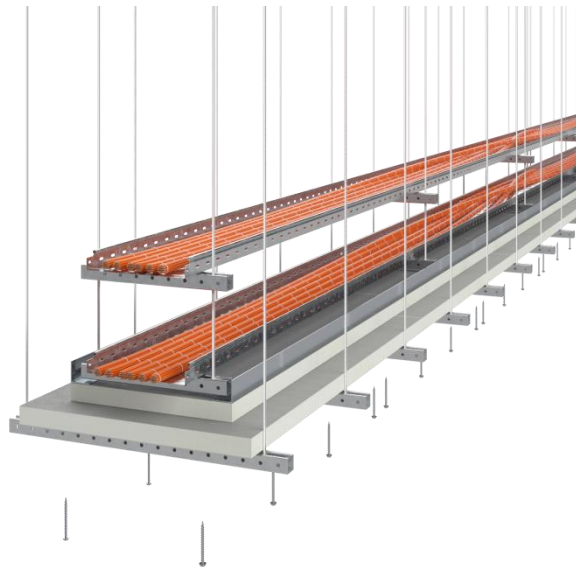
а Установка монтажного уголка DG3030 или DG6060 при помощи саморезов
